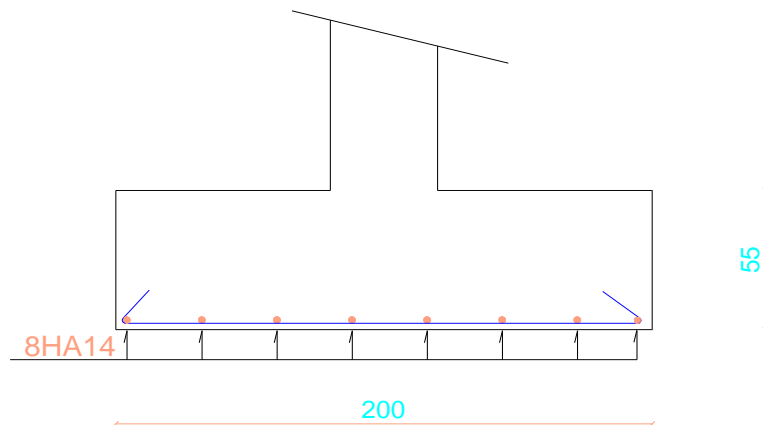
Ferrailage de la semelle intermédiaire dans le sens y-y.
